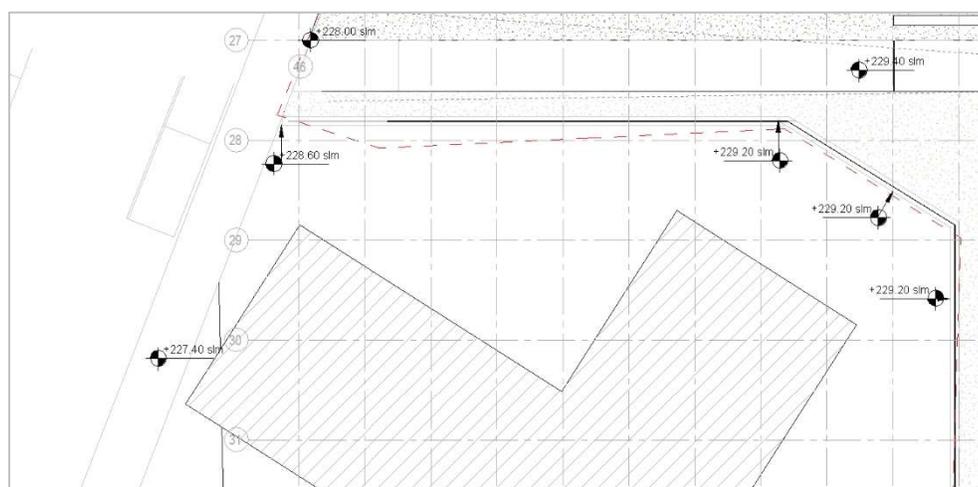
Quote planimetriche del muro di separazione tra l'area di progetto e l'esistente edificio a stella.
